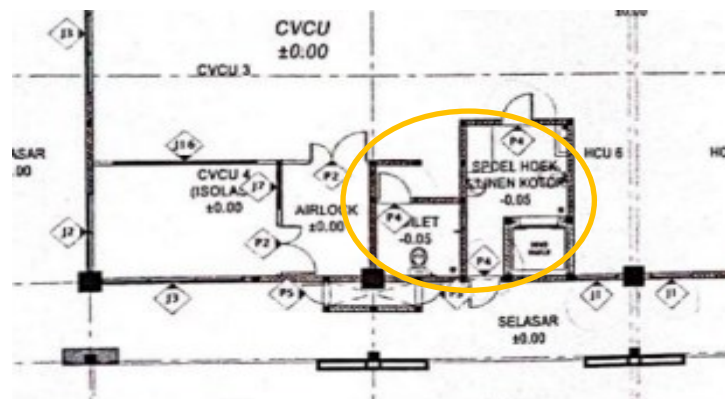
Denah Rencana Pintu Tipe P3.
